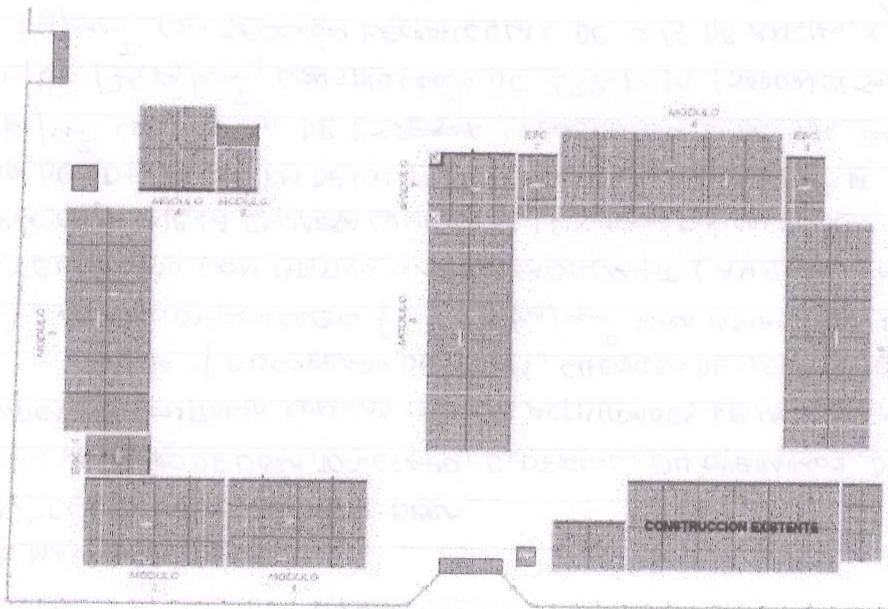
Vista en planta de la I.E. N 81032 en donde se aprecia la proyección de techos con ladrillo pastelero en losas aligeradas.
